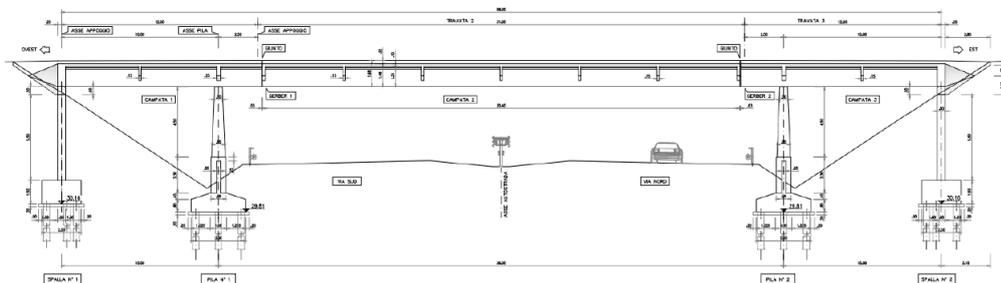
Sezione longitudinale del sovrappasso esistente (Fonte: Allegati alla Lista di controllo)
